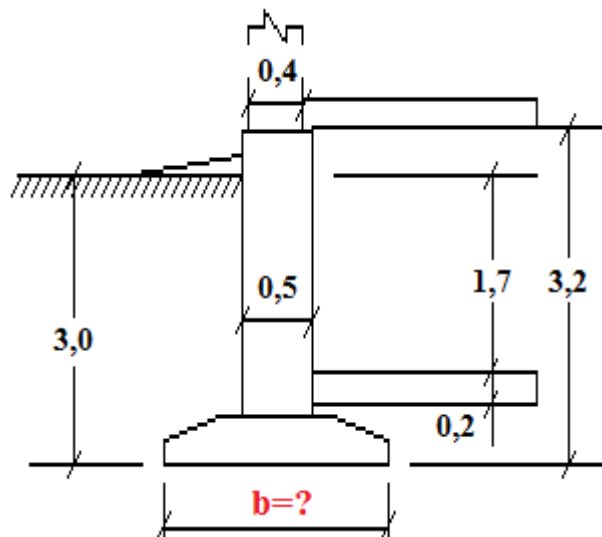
Схема-пример проектируемого ленточного фундамента под наружную стену здания (определение ширины подошвы – b) с основными конструктивными размерами по подвалу
